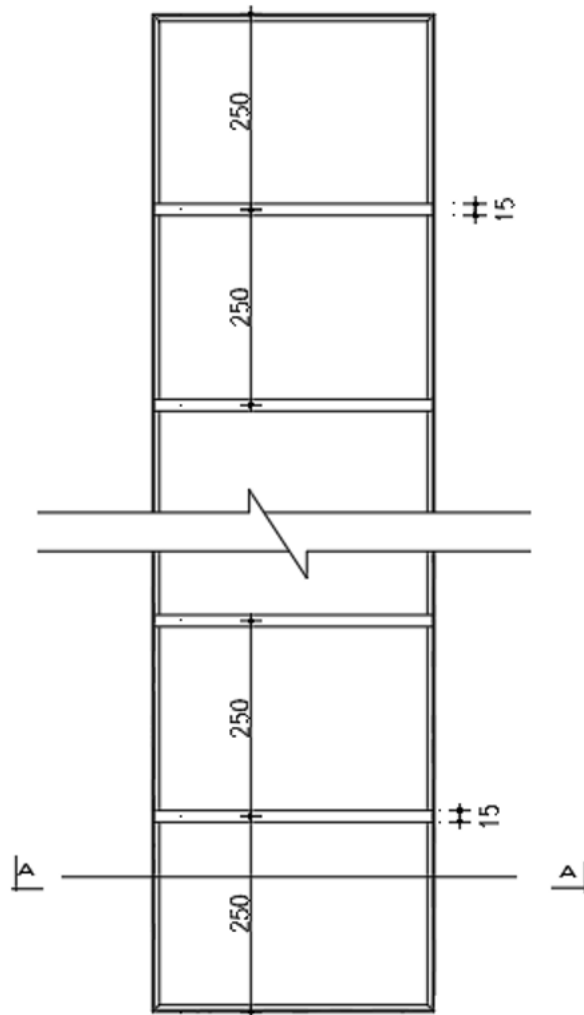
Planimetria dhe prerja e kornizes mbajtëse të rrugës në kurorën e argjinaturës
